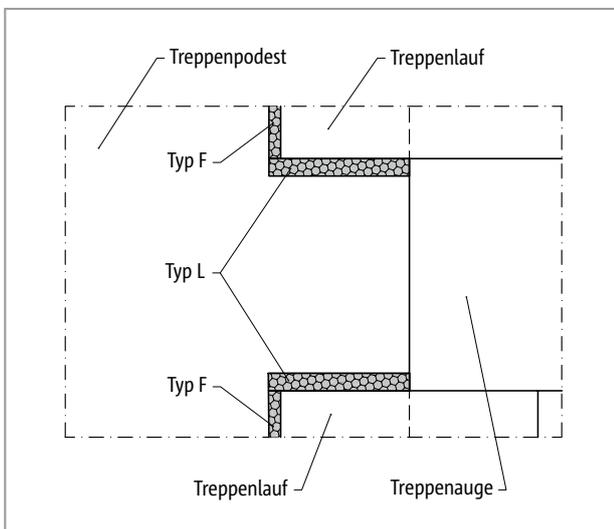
Schöck Tronsole® Typ F: Elementanordnung, Detail A
